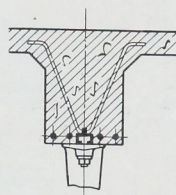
und 1569. Befestigung von Lagern an Betondecken.
